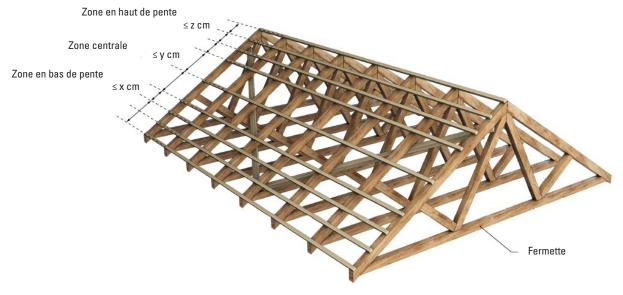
Liteaux fixés à une charpente traditionnelle ou industrialisée
